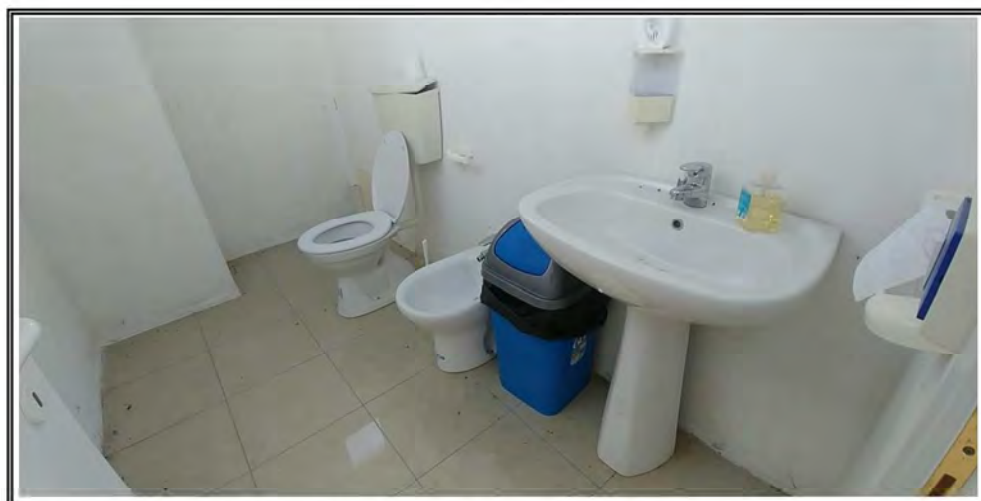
Subalterno 4 – Piano Terra – Servizio igienico
